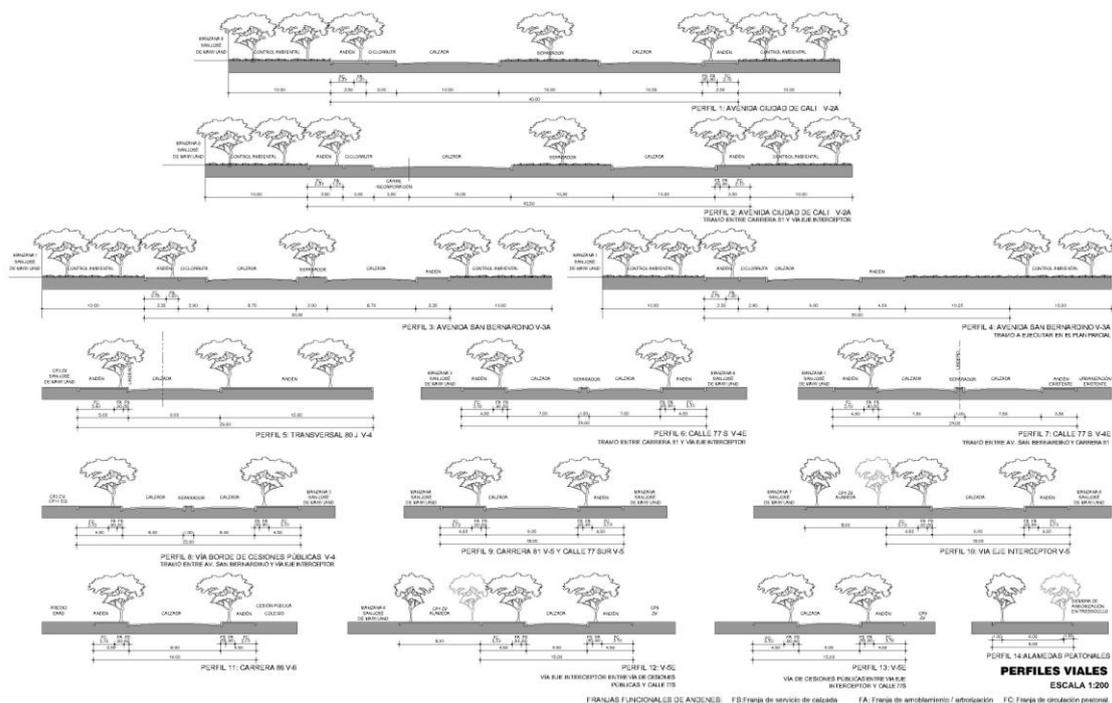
Planteamiento Urbano – Perfiles Viales
